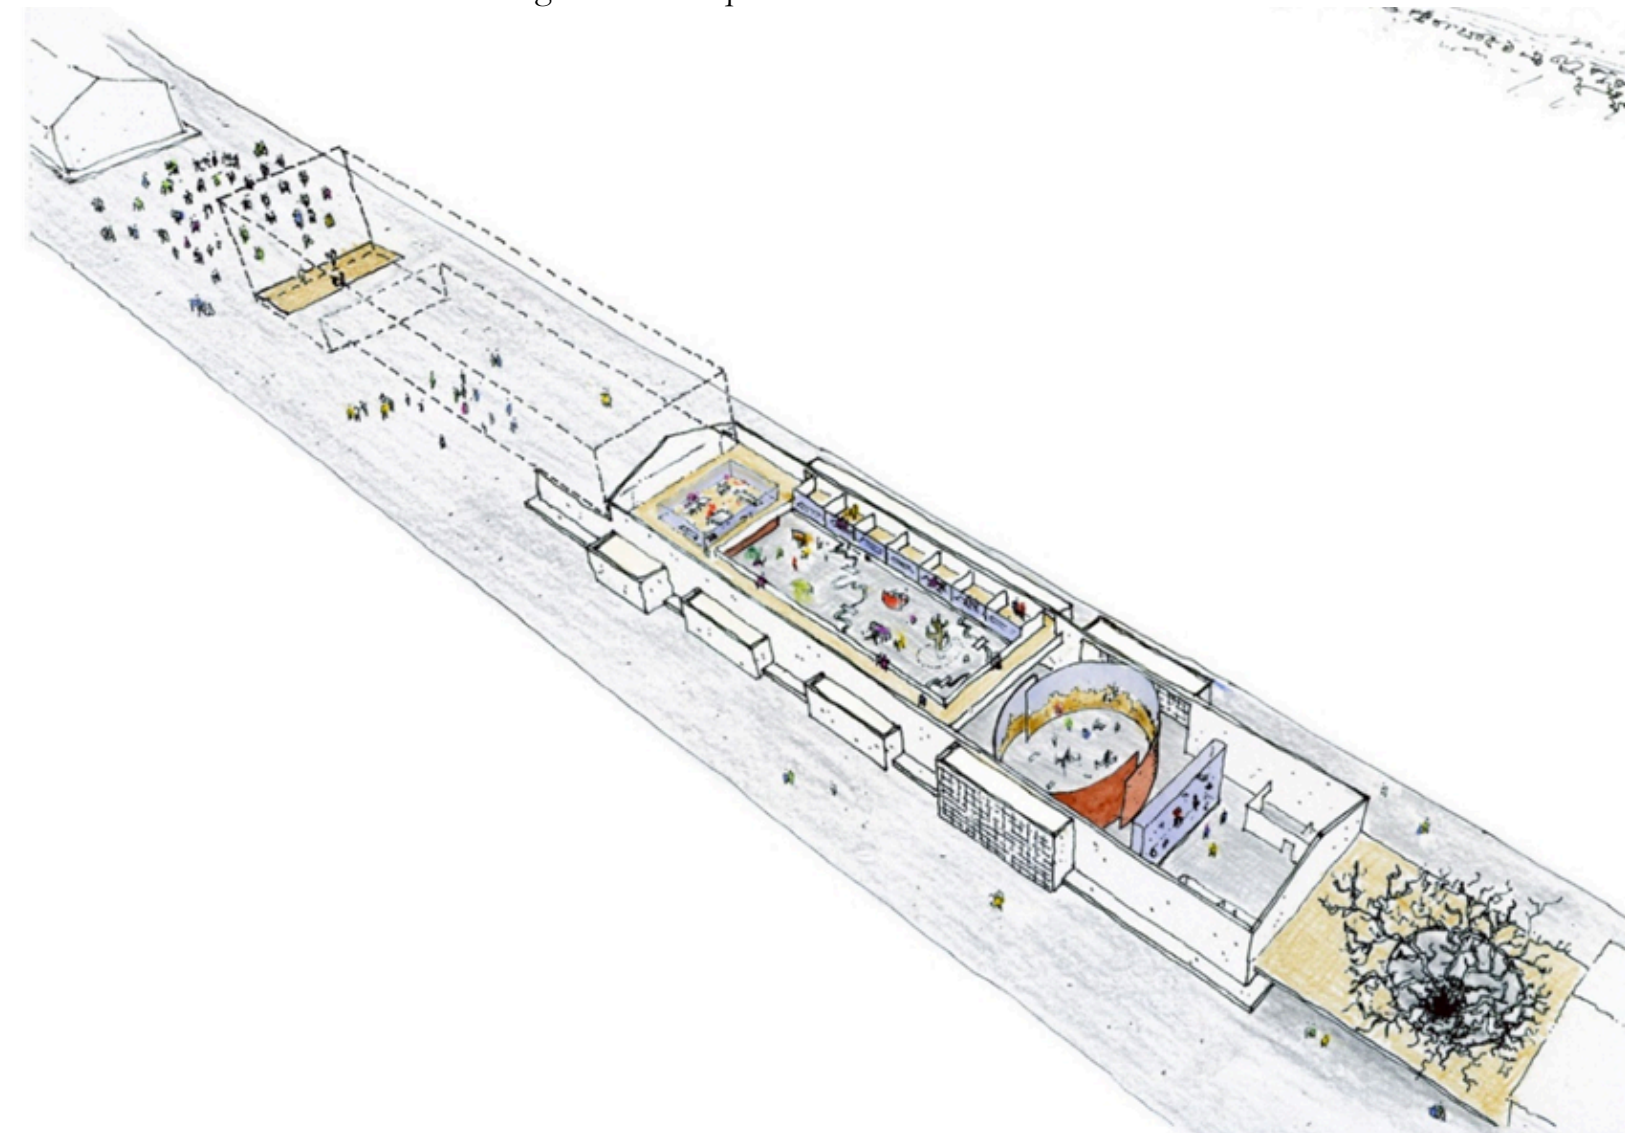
Planta de cobertura do Museu Cais do Sertão.
